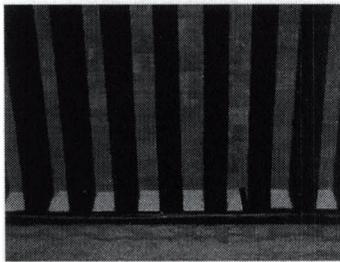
Sistema formal de entrepiso, viga viga, nivel planta baja patio principal.
